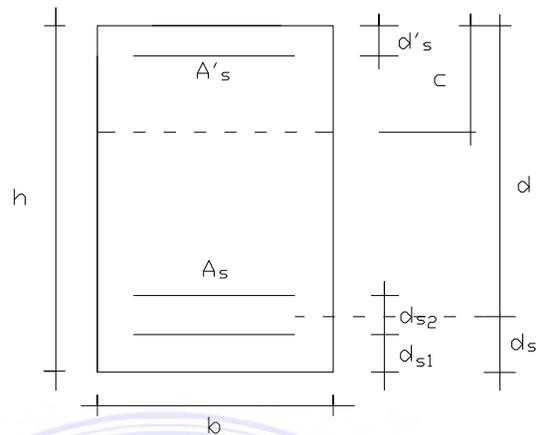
Contoh pemasangan tulangan longitudinal pada balok dan plat
